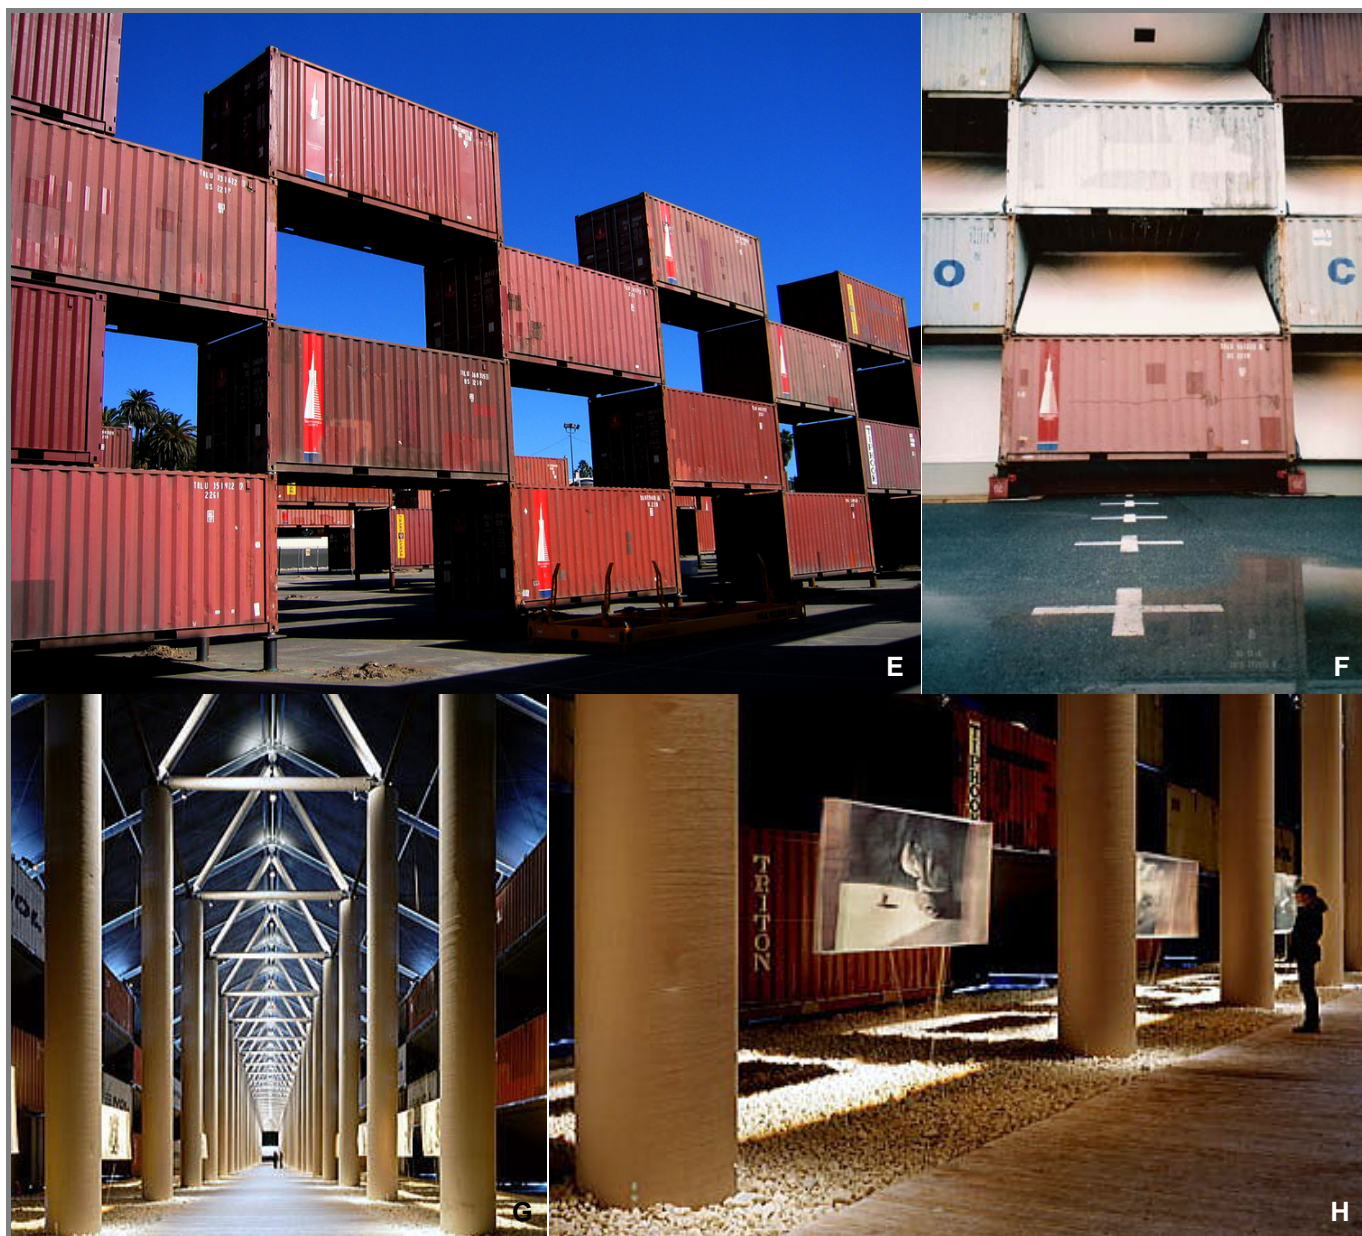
E - Construção da estrutura com CMN's intercalados; Fig. 24.F - Pormenor da fachada exterior intercalada de CMN's e planos inclinados de lona; Fig. 24.G e 24.H - Vista interior da estrutura em tubos de papel. (24.E e 24.F - RSCP; 24.G e 24.H - Michael Moran Photography inc. 2005).
